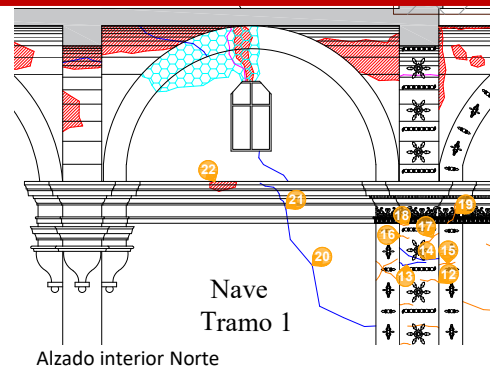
Detalle de afectaciones existentes en muro interior norte
